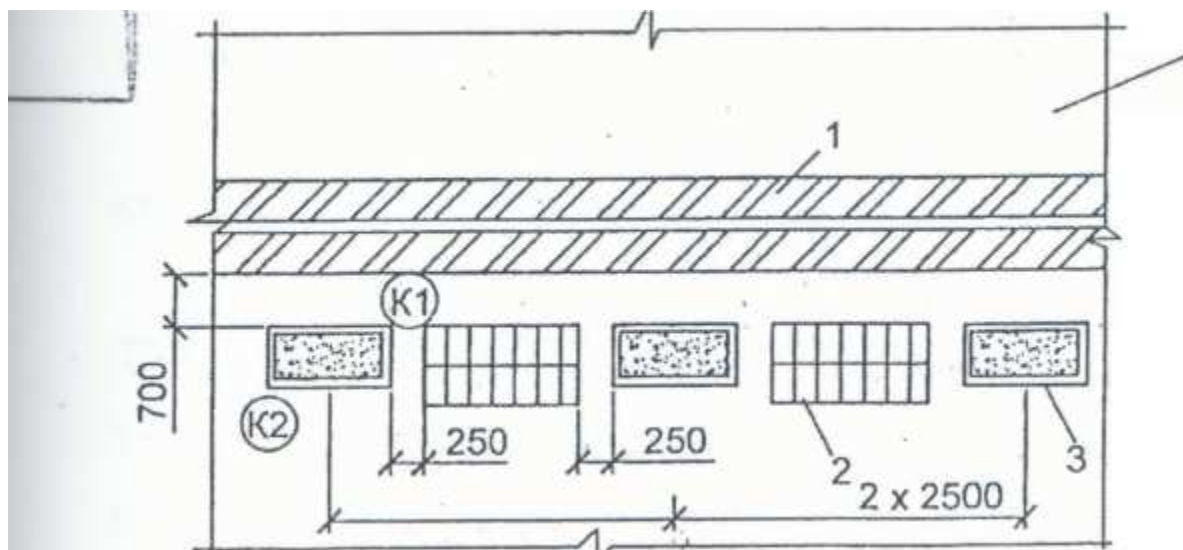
Схема организации рабочих стен с уровня перекрытия
